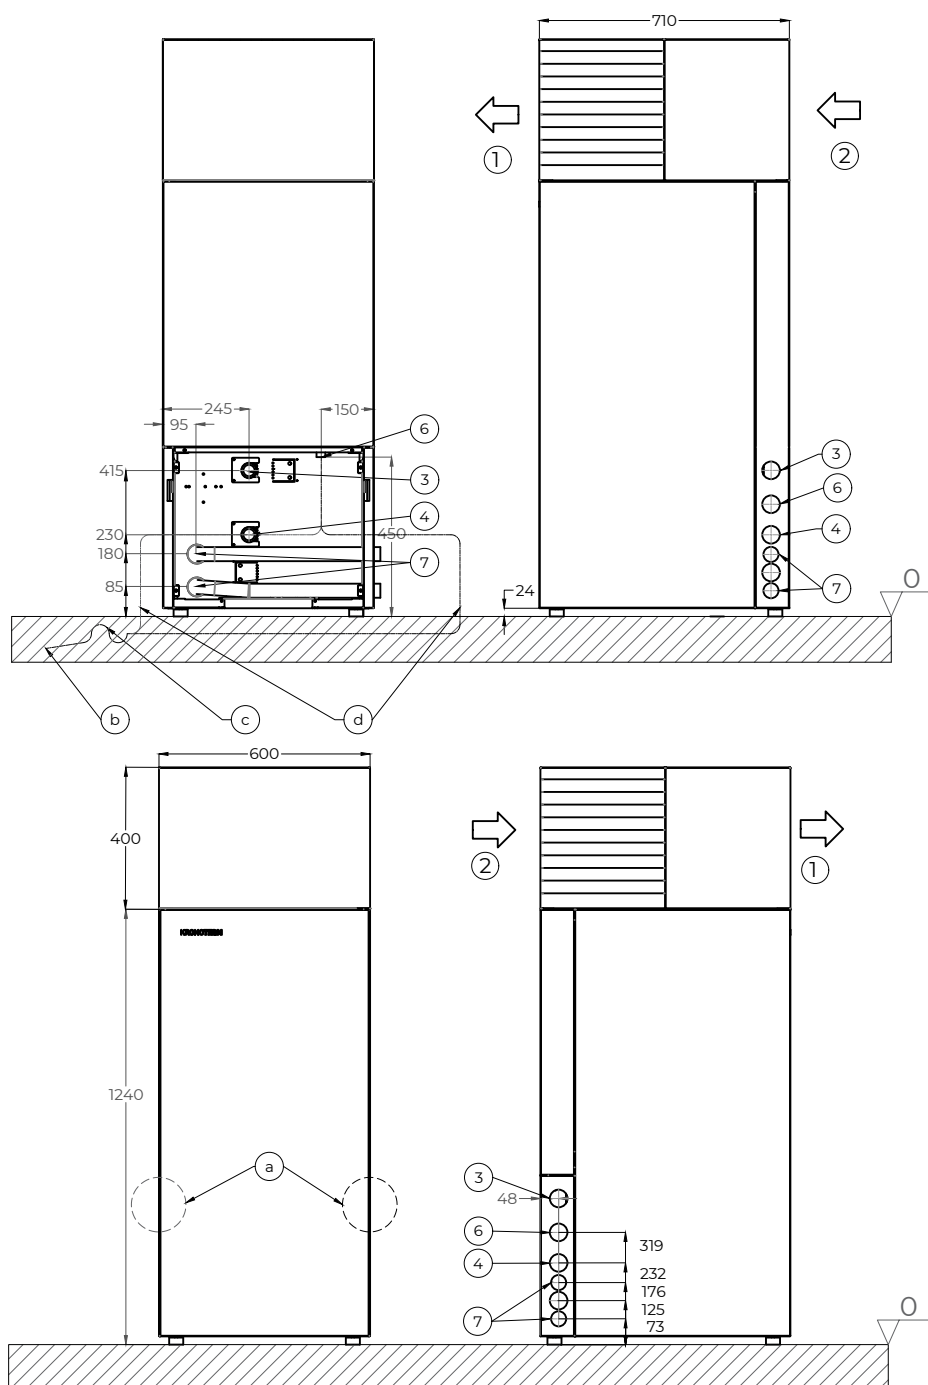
Bijlage 14 - Installatievoorbereidingsplan voor VERSI-X
